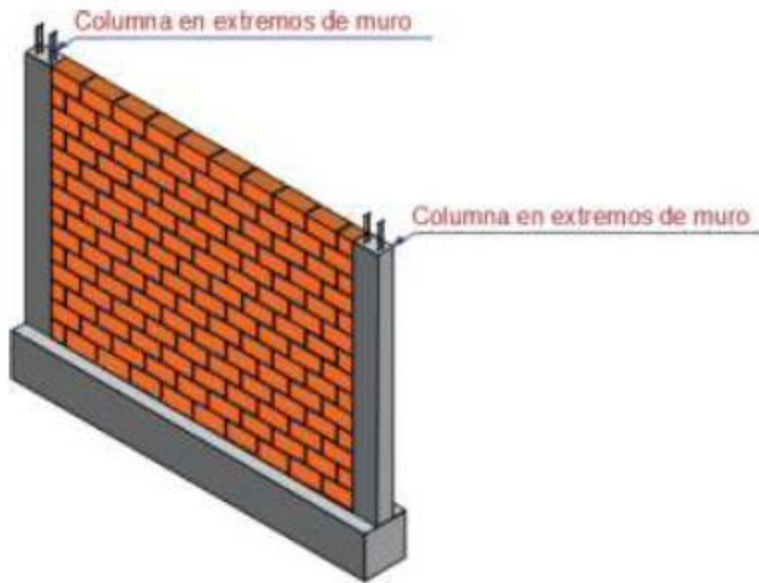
Muros terminado, en espera de colado de amarre y techo.
